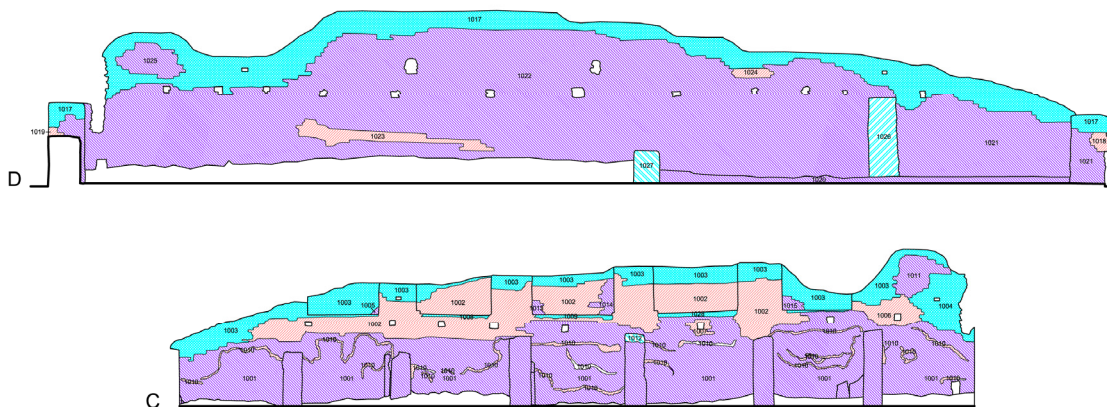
Alzados extendidos de la estructura semicircular. En violeta la obra original, en naranja la restauración de 1915, en azul la restauración de 1963.
